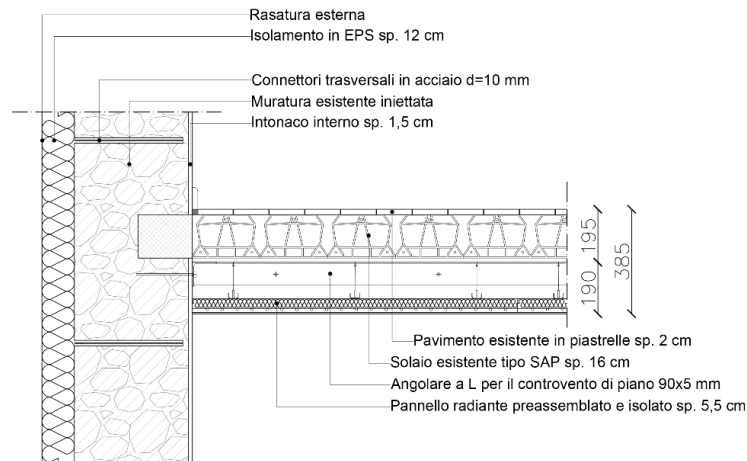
Dettaglio in sezione degli interventi di consolidamento mediante controventi in acciaio, collegamenti e pannello radiante.
